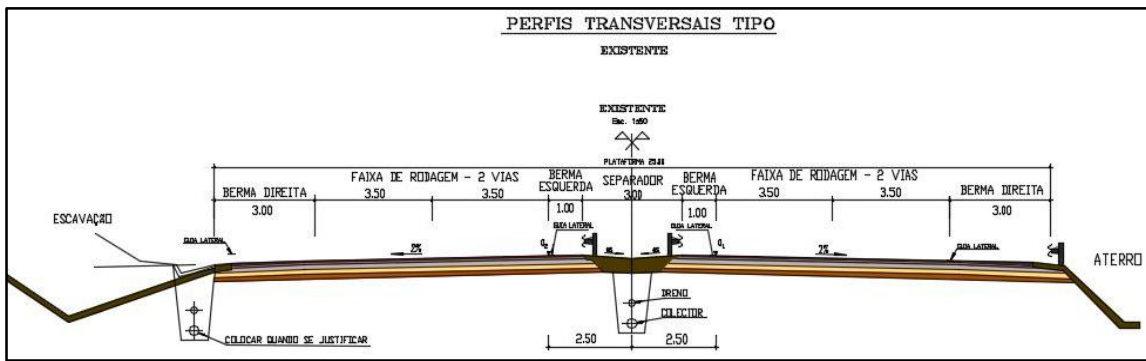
Perfil Transversal Tipo Existente [19]
